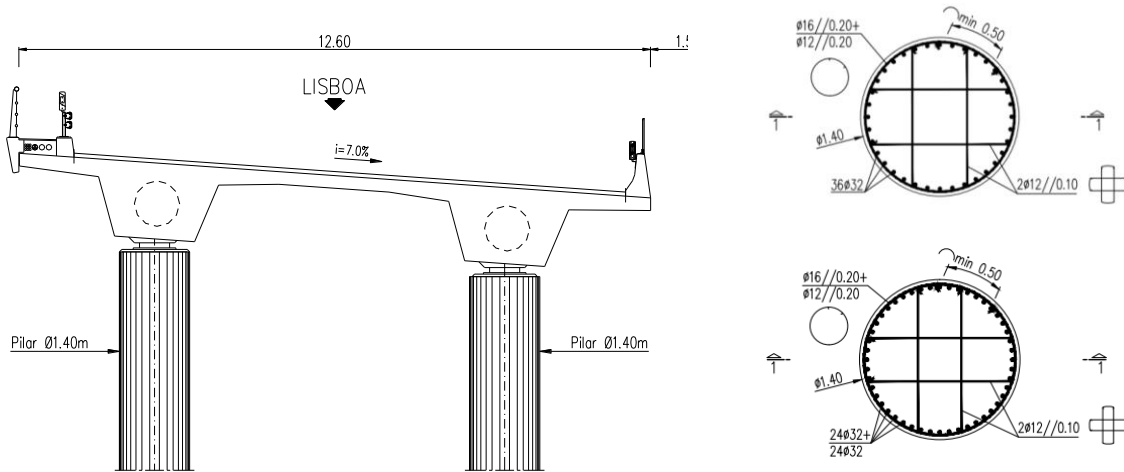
Corte junto dos pilares e secção transversal dos pilares - P1 e P2.
